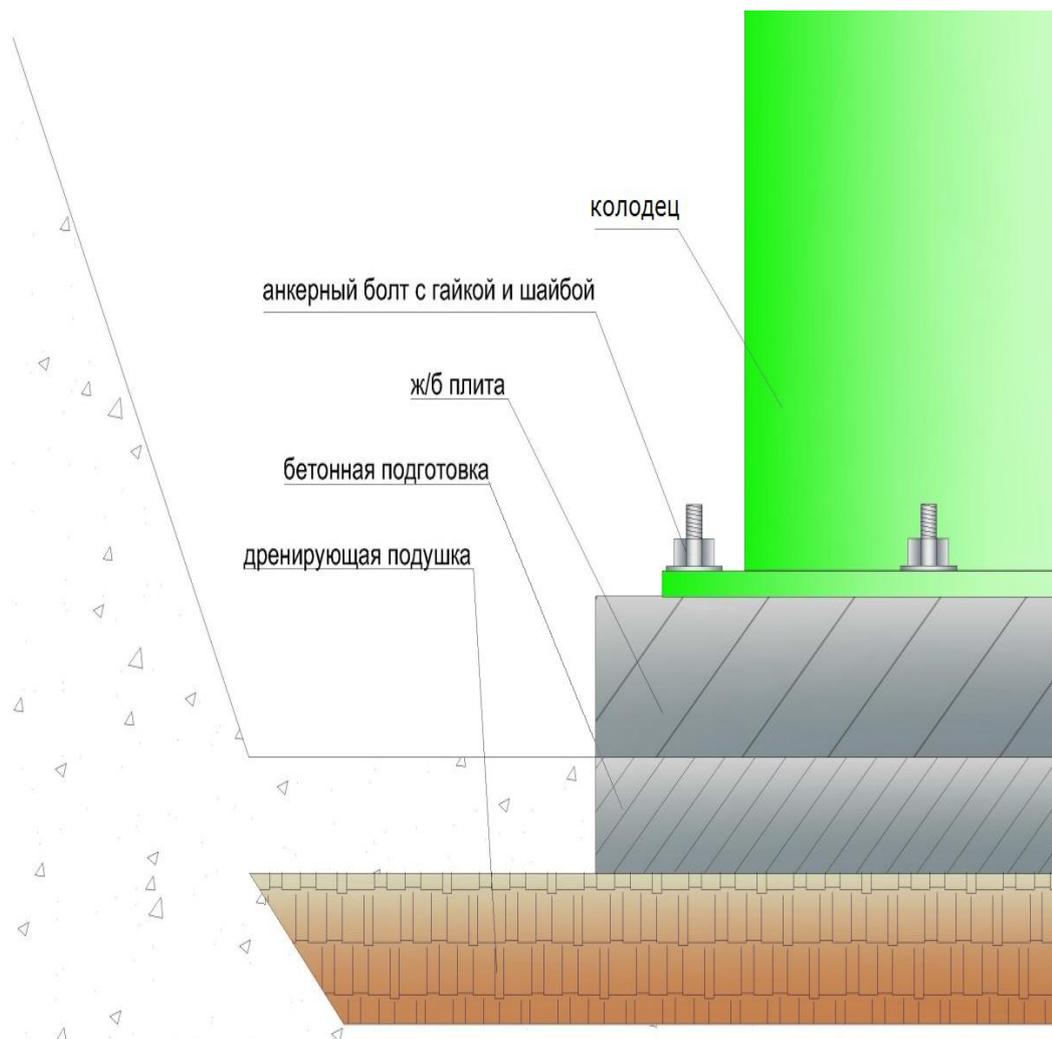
Схематичное крепление колодца к бетонной плите.
